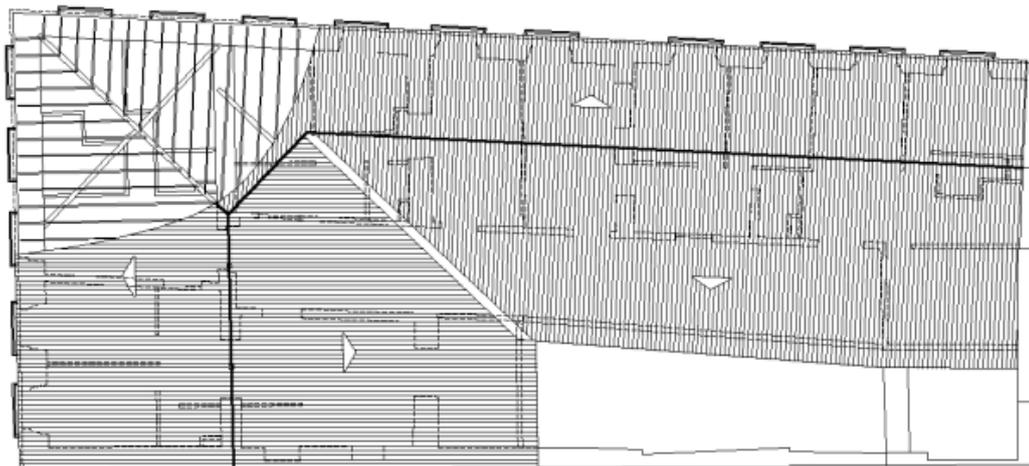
Ilustração de Planta de Cobertura e desenho do lote.
